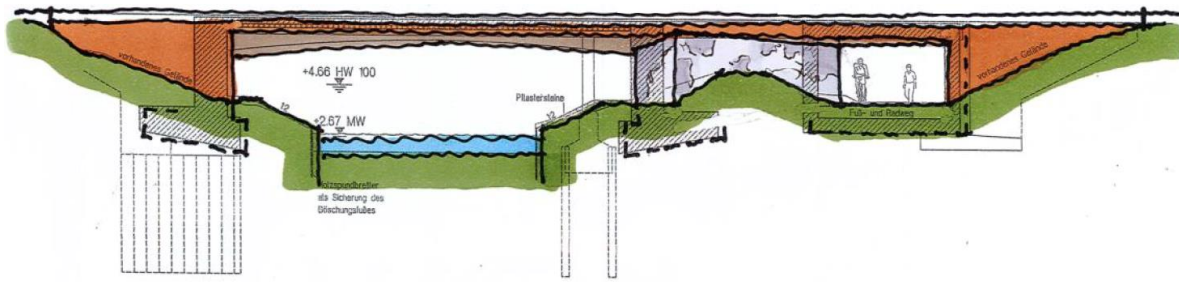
Planung des Ersatzneubaus BW 443 - 443 – Längsschnitt Rahmentragwerk und Unterföhrungsbauwerk
